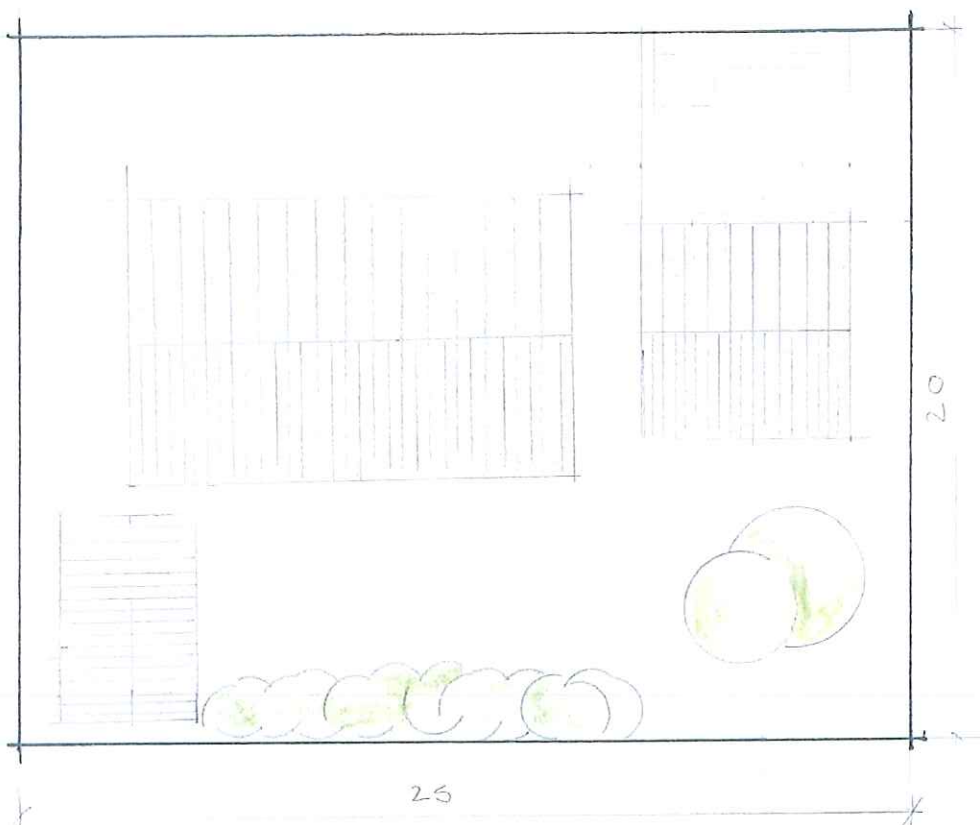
Haus 8 x 12,5 m mit Garage 6 x 6 m mit Zufahrt 6 x 5,5 m und Nebengebäude 4,16 x 6 m
